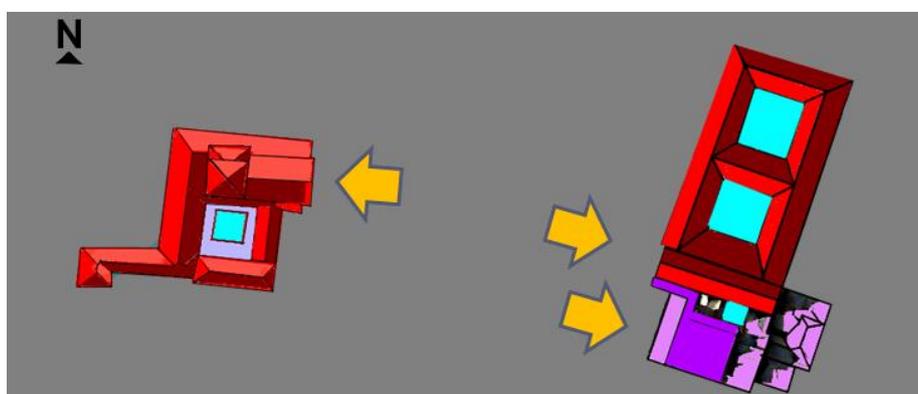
Plantas dos conventos carmelitas de São Salvador da Bahia.
